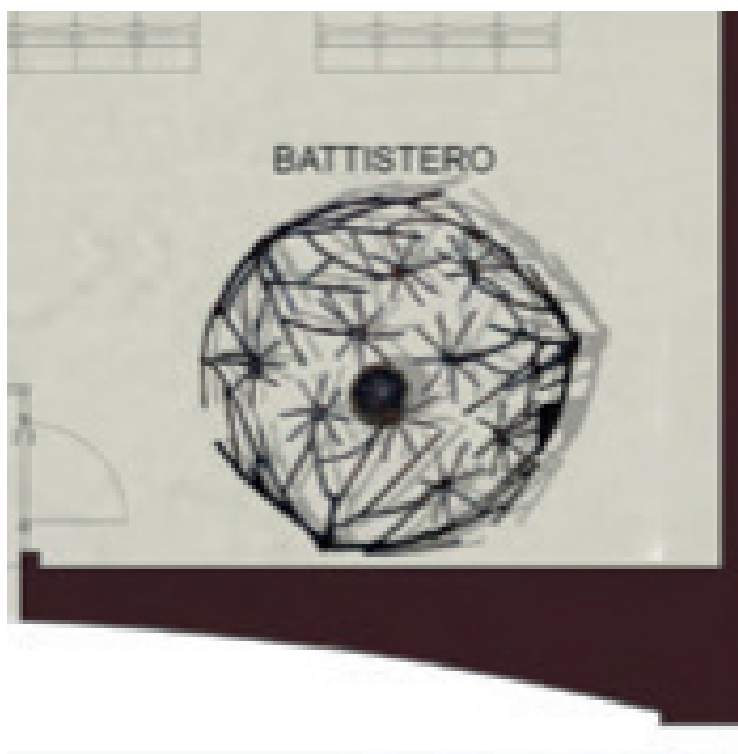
dettaglio planimetrico dell'aula liturgica e del battistero rimasto allo studio (2012-13)
